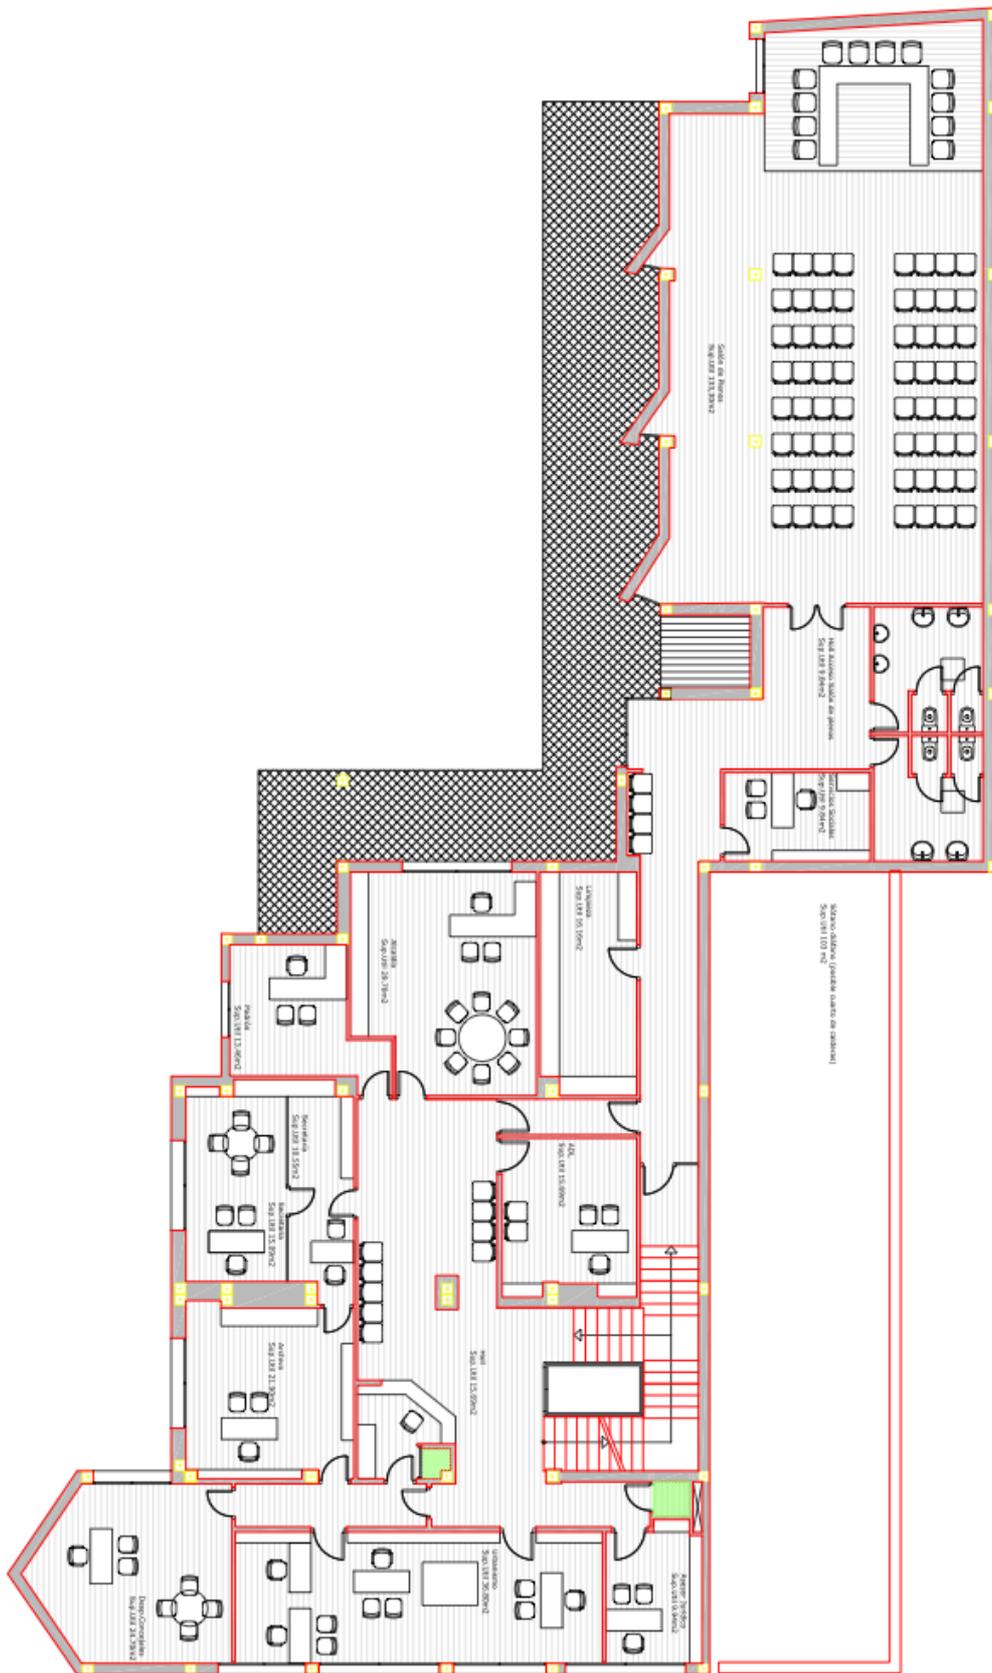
Plano de distribución del edificio del Ayuntamiento Planta Primera.
